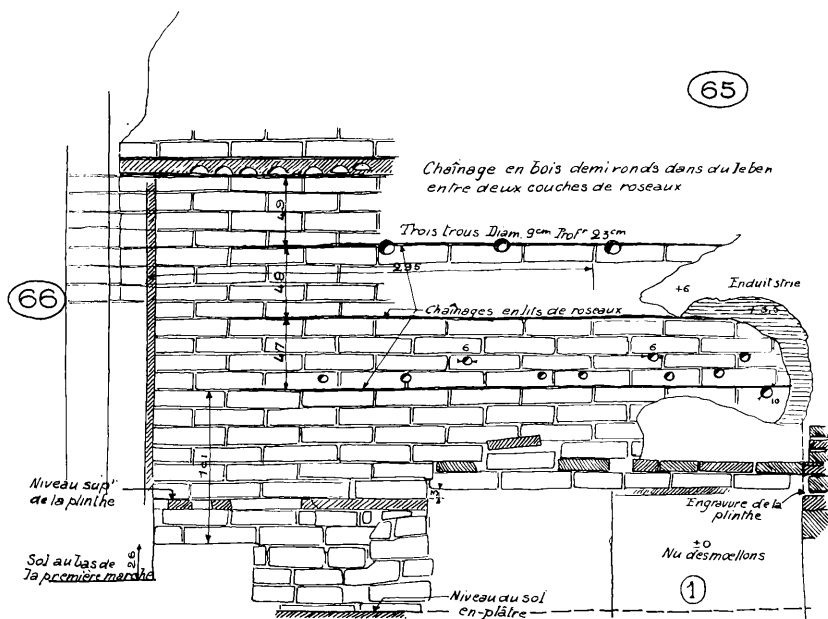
Salle du trône 65. Élévation du mur est avec détail des chaînages.
